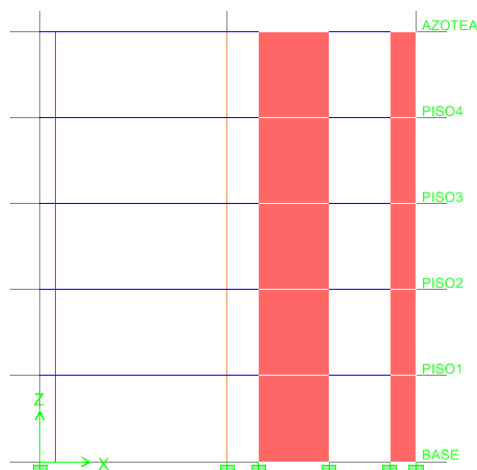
Elevación pórtico eje 4. Corrección del proceso constructivo (Desplazamiento vertical restringido en los nudos de columna C-02).
